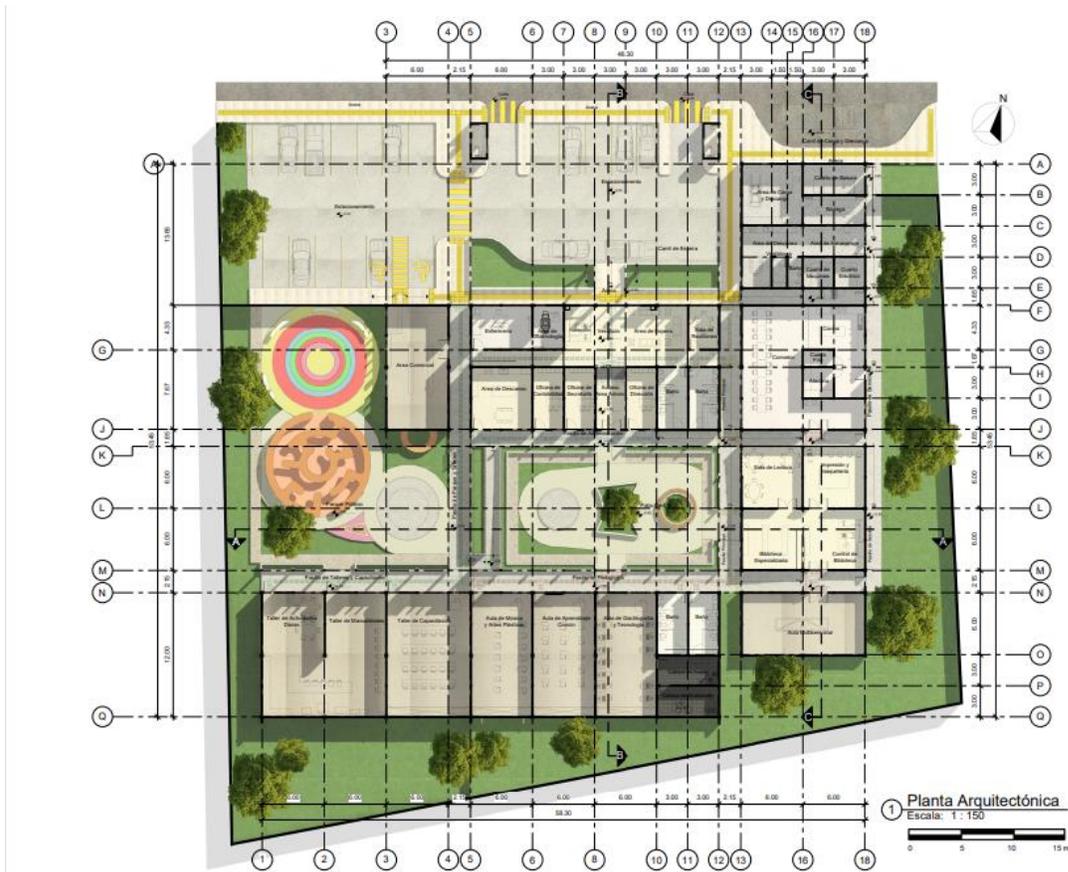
Planta arquitectónica. Fuente: Elaboración propia
